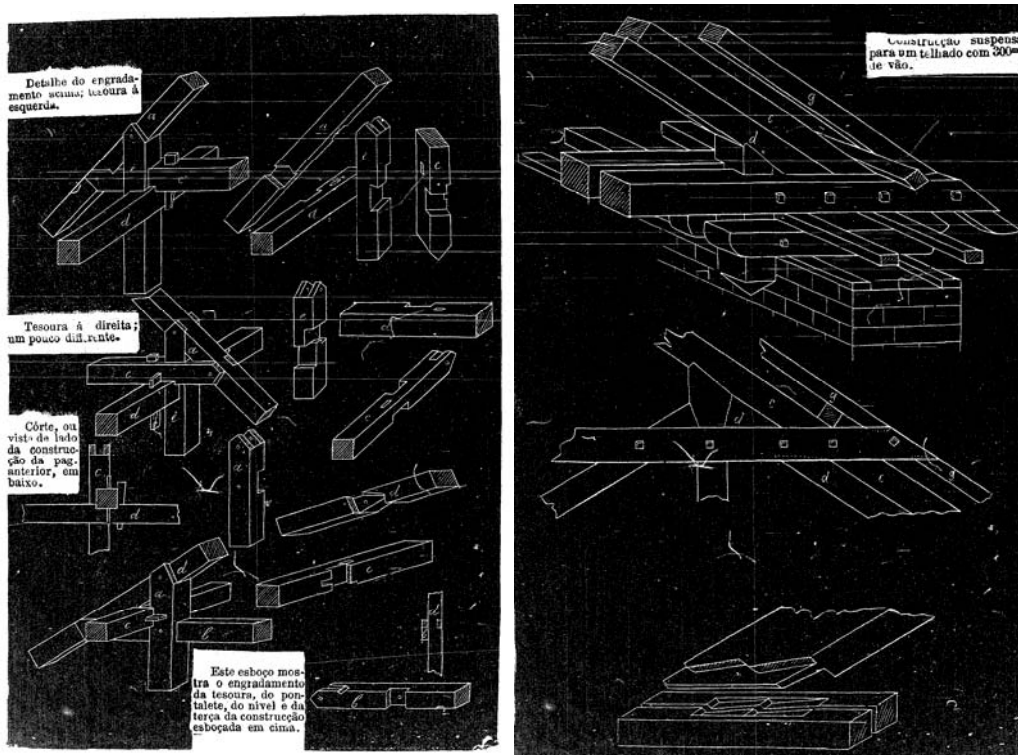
Detalhes de ensabladuras utilizadas nas estruturas de telhados.
